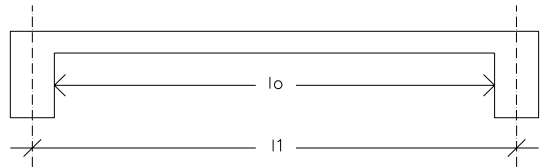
Vigas con restricción parcial al giro en el apoyo.
